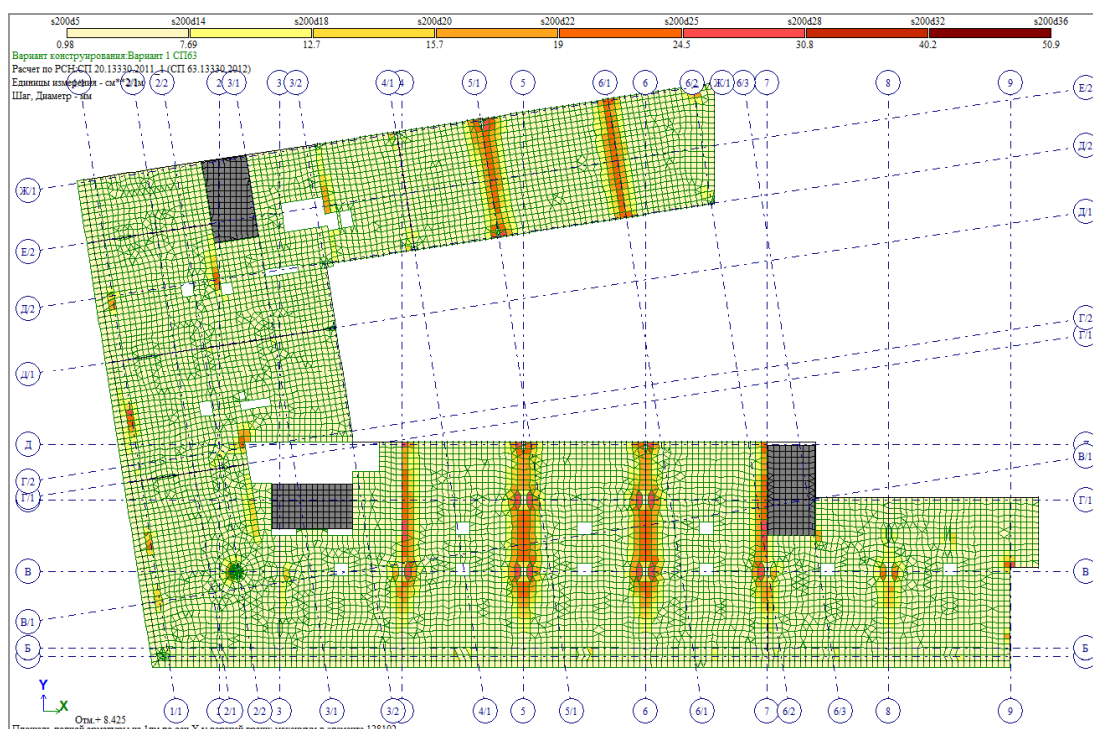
Площадь верхнего армирования вдоль буквенных осей
